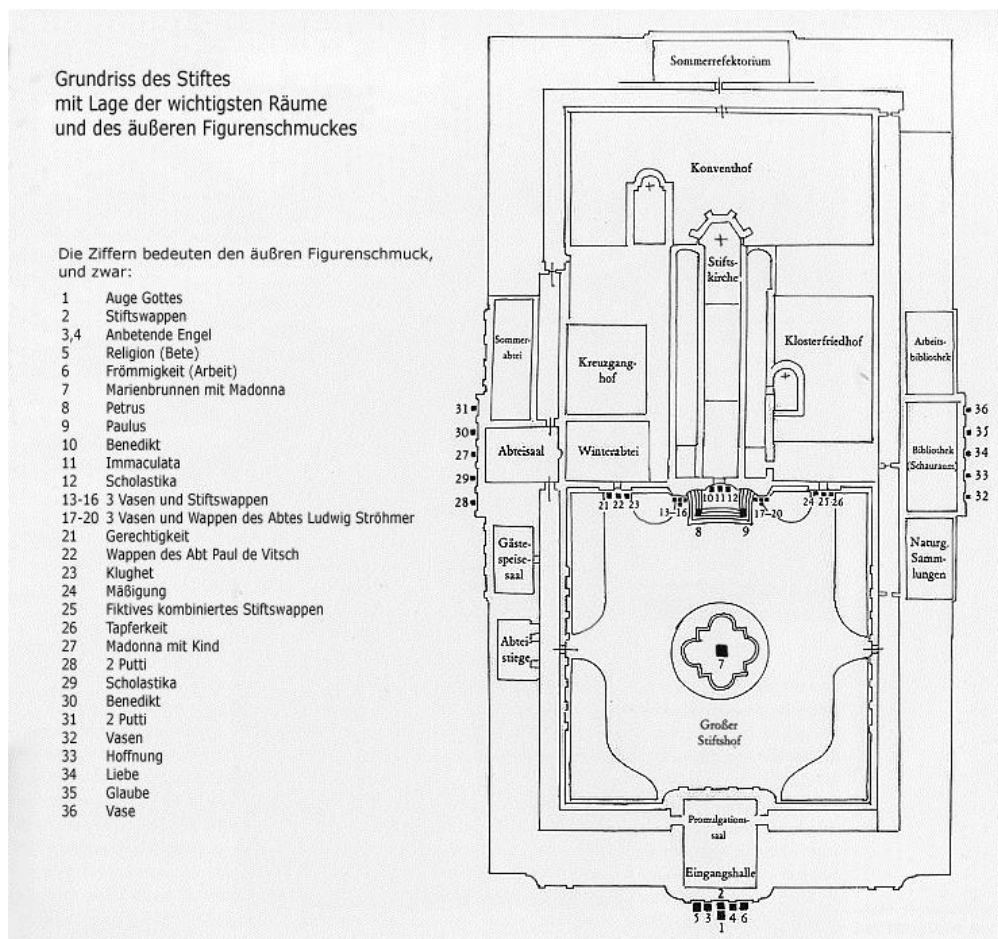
Grundriss des neuen Klosterplanes nach Munggenast
